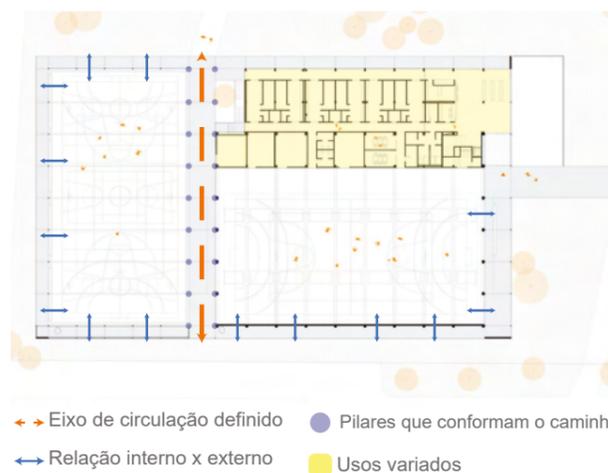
Planta baixa térreo – Pavilhão Desportivo Municipal de Vila-Seca
